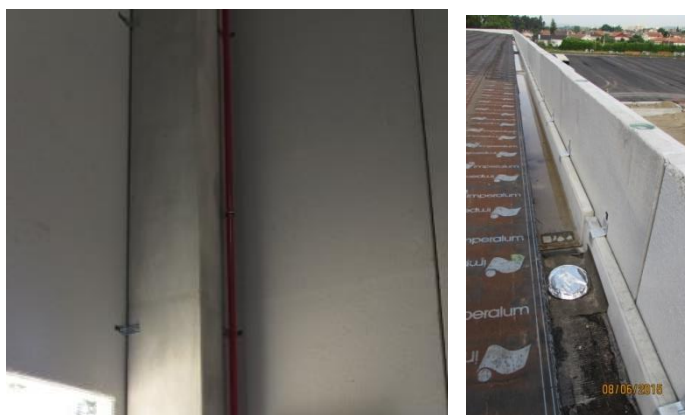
Exemplo das fixações utilizadas no pavilhão: painel – pilar de betão (à esquerda) e painel – viga caleira (à direita)
